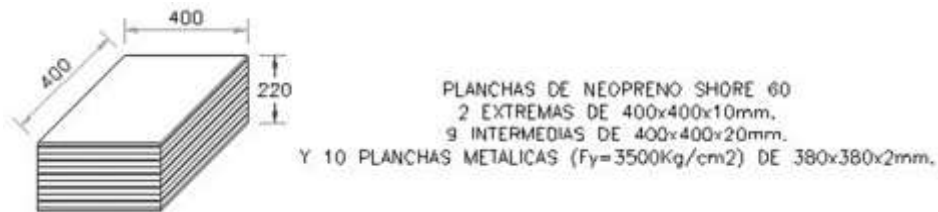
Detalle típico de apoyos elastoméricos en estribos.
